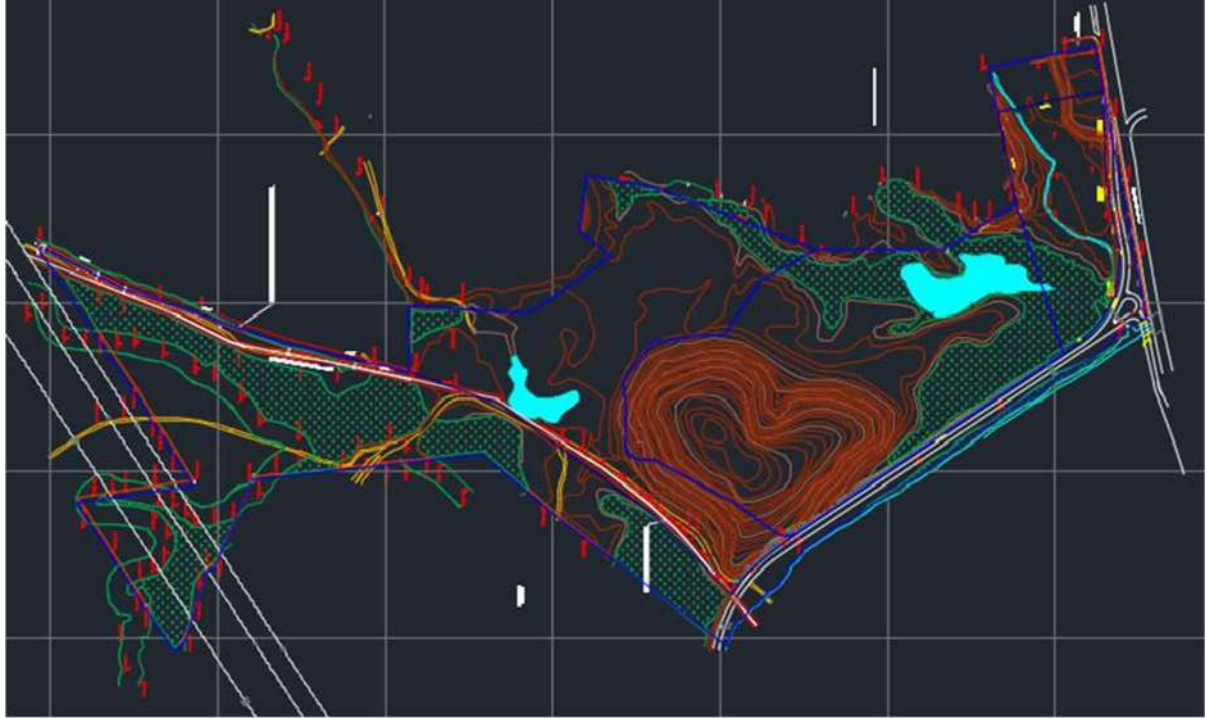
IMAGEM DE SATÉLITE X PROJEÇÃO DA PLANTA DE DESMEMBRAMENTO
